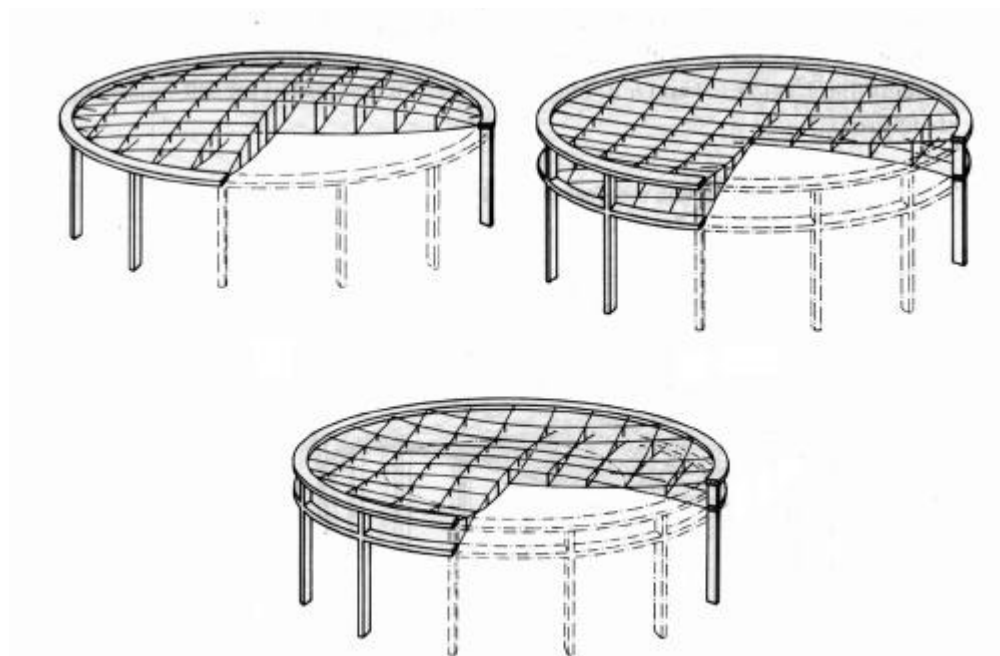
Reticulado tridimensional de cabos.
